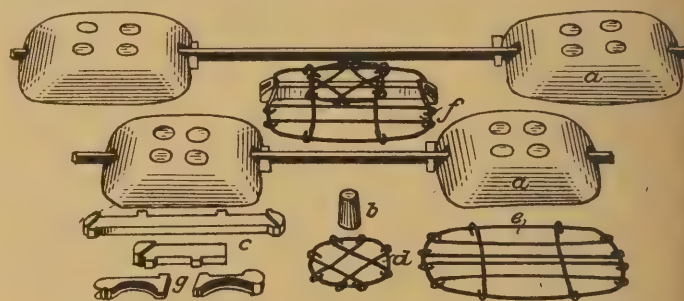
Ausführungen der Stent-Schienenstütze für verschiedene Spurweiten. a Eisenbetonstütze; b Holzdübel; c lange und kurze Führung für die Verbindungsstange; d obere, e untere Gittereinlage; f mit Führung zusammengebaute Einlagen; g kürzere, doppelt einzubauende Führungen für die Verbindungsstange.
